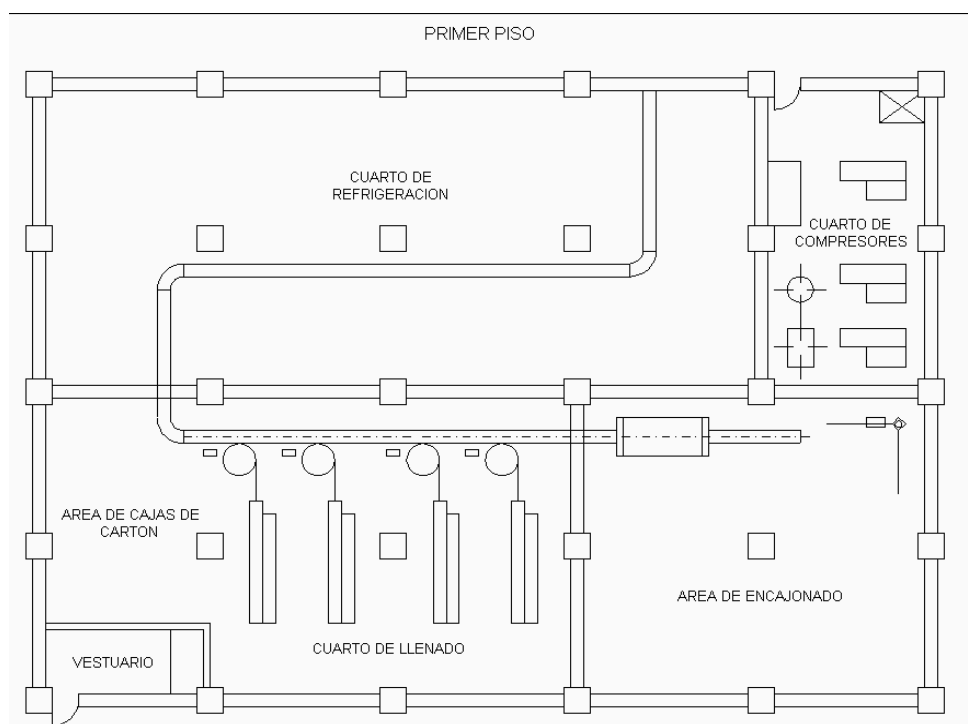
LAY OUT PLANTA DE BEBIDAS ÁREA DE LLENADO
